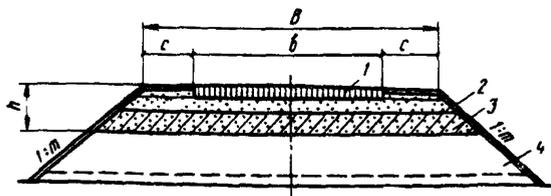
Конструкция насыпи из грунтов повышенной влажности с рабочим слоем из улучшенного грунта или обрботанного золой уноса, известью, цементом; 1 - основание и покрытие; 2 - морозозащитный (дренирующий) слой (по расчету); 3 - рабочий слой из грунта с $K_y = 1 \pm 0,98$; 4 - тело насыпи из грунта повышенной влажности с $K_y \geq 0,93$
